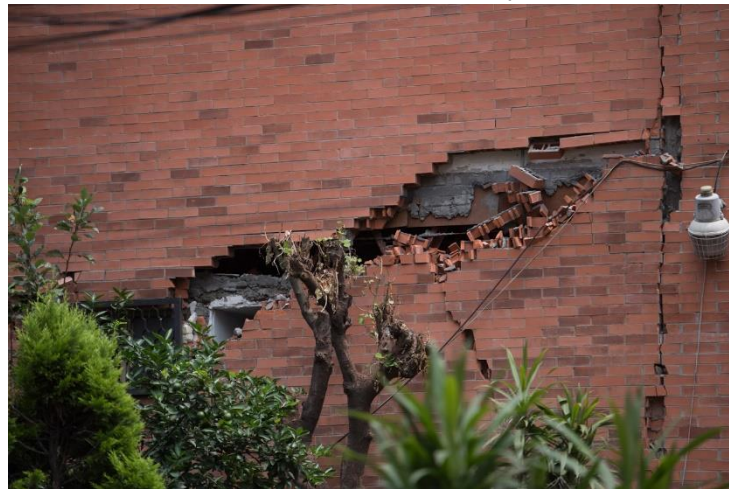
Resumen de edificios con fallas fuera del plano en muros considerados como no estructurales
